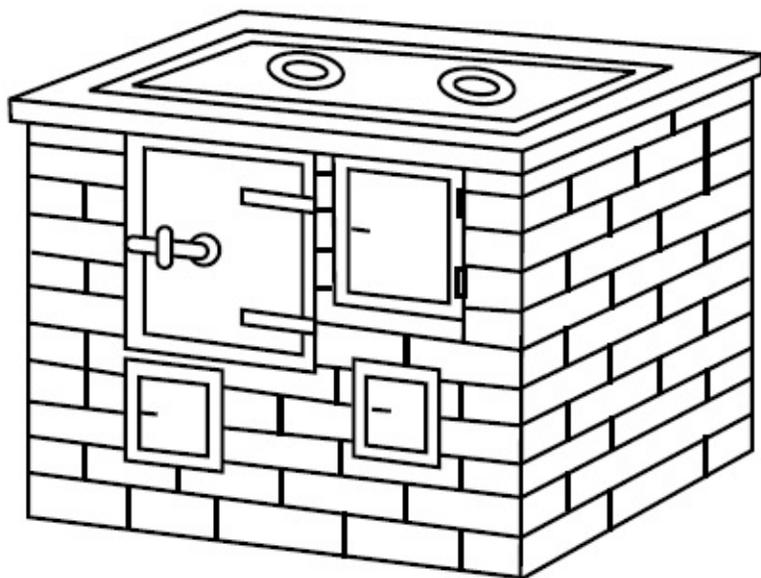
Кухонная плита с духовкой: 1 —чистка; 2 – духовка; 3 – топливник; 4 – поддувало
